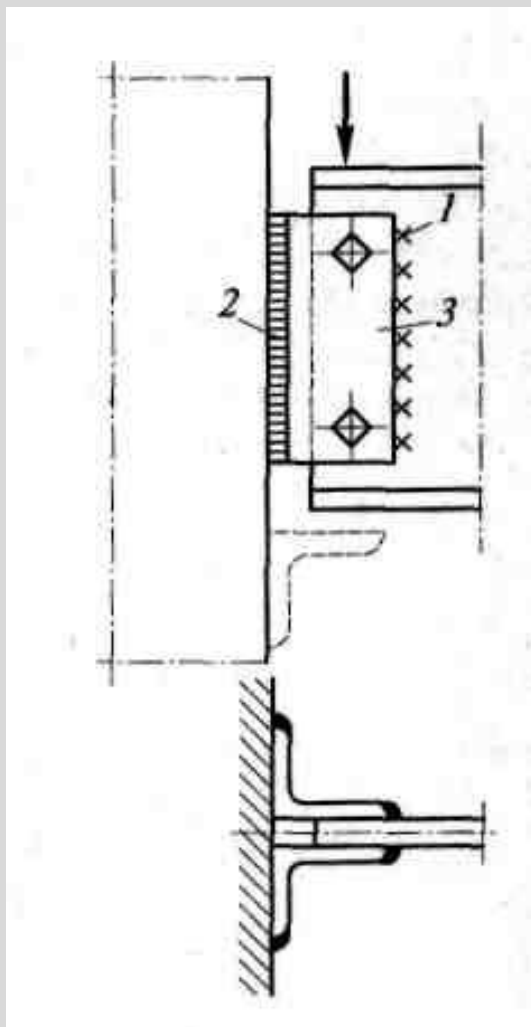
Гибкое (полужесткое) прикрепление балки к колонне (схема):
